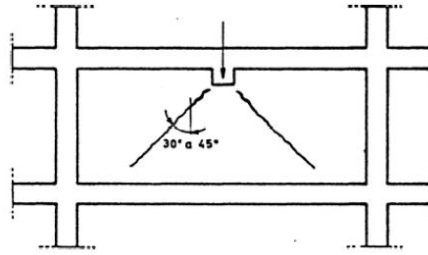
Fissuração em alvenaria devido a apoio de uma viga [1]
